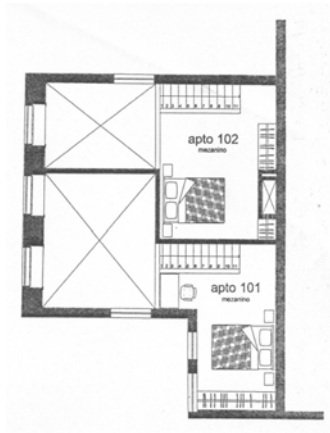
Rua Francisco Muratori, 38 – Planta baixa mezanino (FREIRE, 1999, p. 3).
